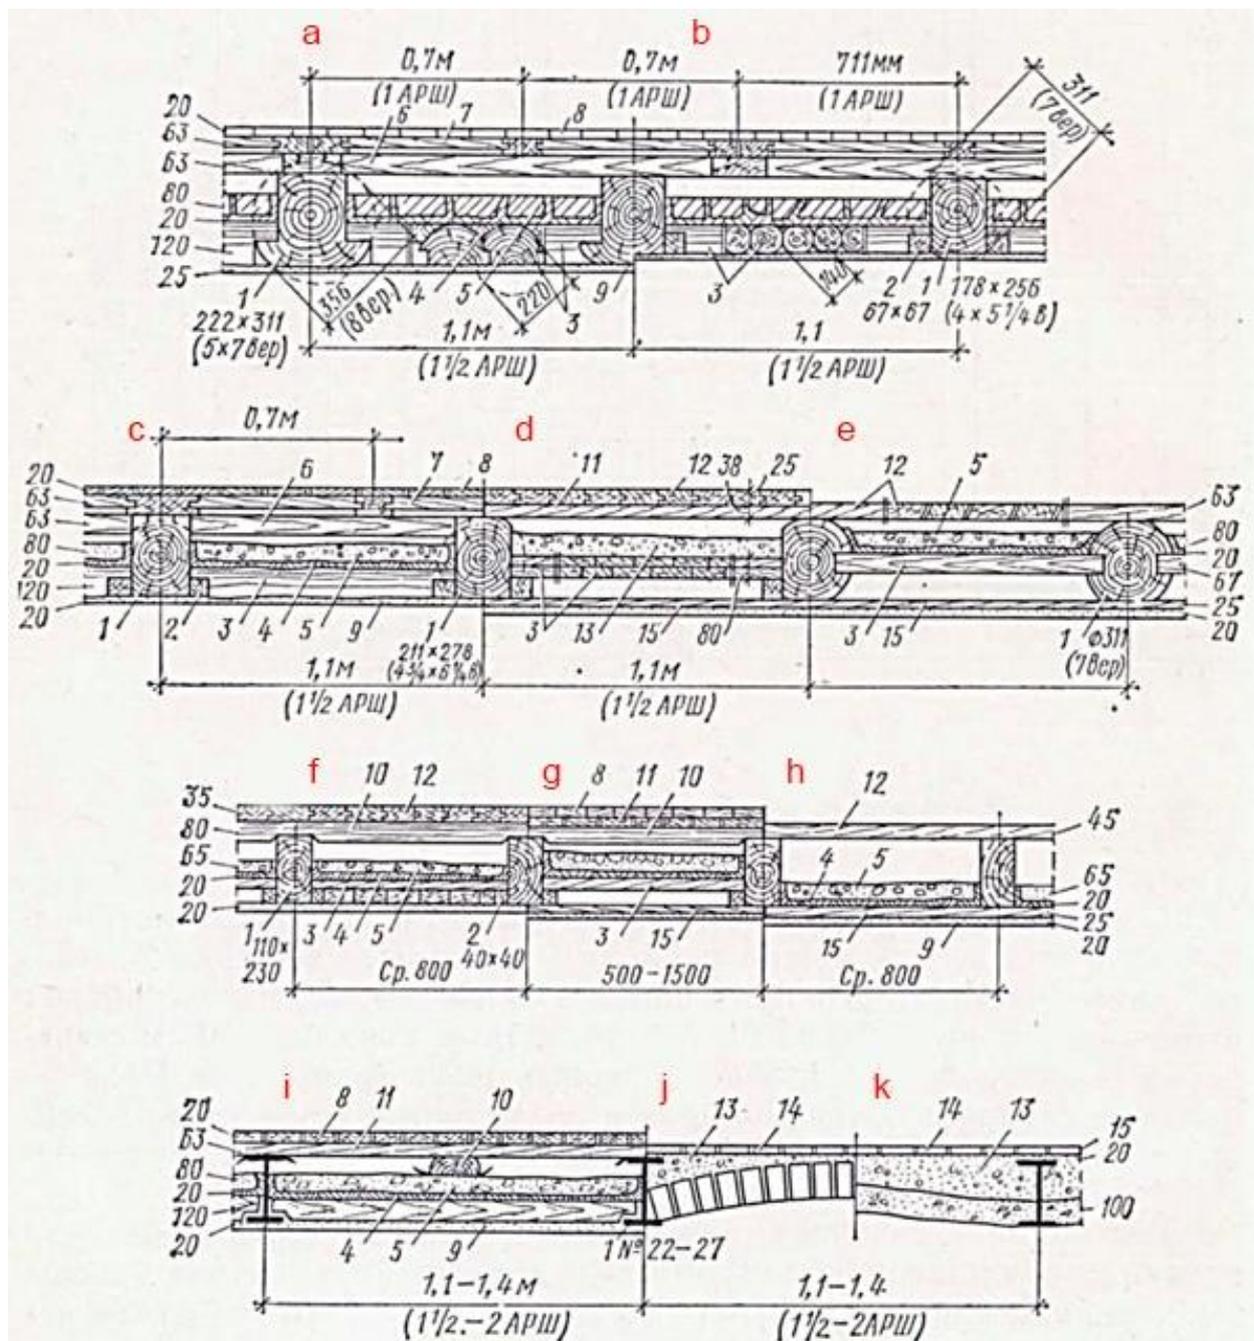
Перекрытия в зданиях рядовой застройки конца XIX – начала XX веков: а – перекрытие по деревянным балкам с черепами, обрешетка на балках, накат из пластин; б – то же, балки с черепными брусками, подбор из накатника; с – то же, обрешетка между балками; д – то же, балки с жуковинами, накат (подбор) из двух слоев досок, подшивной потолок, пол из двух слоев досок (черный и чистый); е – то же, балки круглые, подбор в пазах, пол из шпунтованных досок, подшивной потолок; ф – балки из брусьев, щитовой накат (доски внизу, рейки сверху), пол из шпунтованных досок по лагам; г – дощатый накат, подшивной потолок, пол из двух слоев досок по лагам; h – подшивной накат, дощатый пол; i-k – перекрытия по металлическим балкам: i – с деревянным заполнением; j – с кирпичными сводами; k – с бетонным заполнением; 1 – балка; 2 – черепной брусок; 3 – накат; 4 – глиняная смазка; 5 – выстилка кирпичом, засыпка строительным мусором, легкий бетон; 6 – обрешетка; 7 – щит основания паркета; 8 – паркет; 9 – штукатурка; 10 – лага; 11 – пол черный дощатый; 12 – то же, чистый; 13 – тощий бетон; 14 – пол из керамических плиток на цементном растворе; 16 – подшивка потолка [34].
